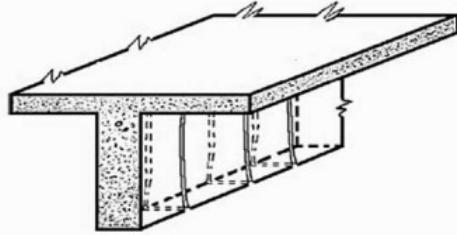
Fissuração por deficiência de armaduras para combate aos momentos ventolentes, na face inferior da laje
